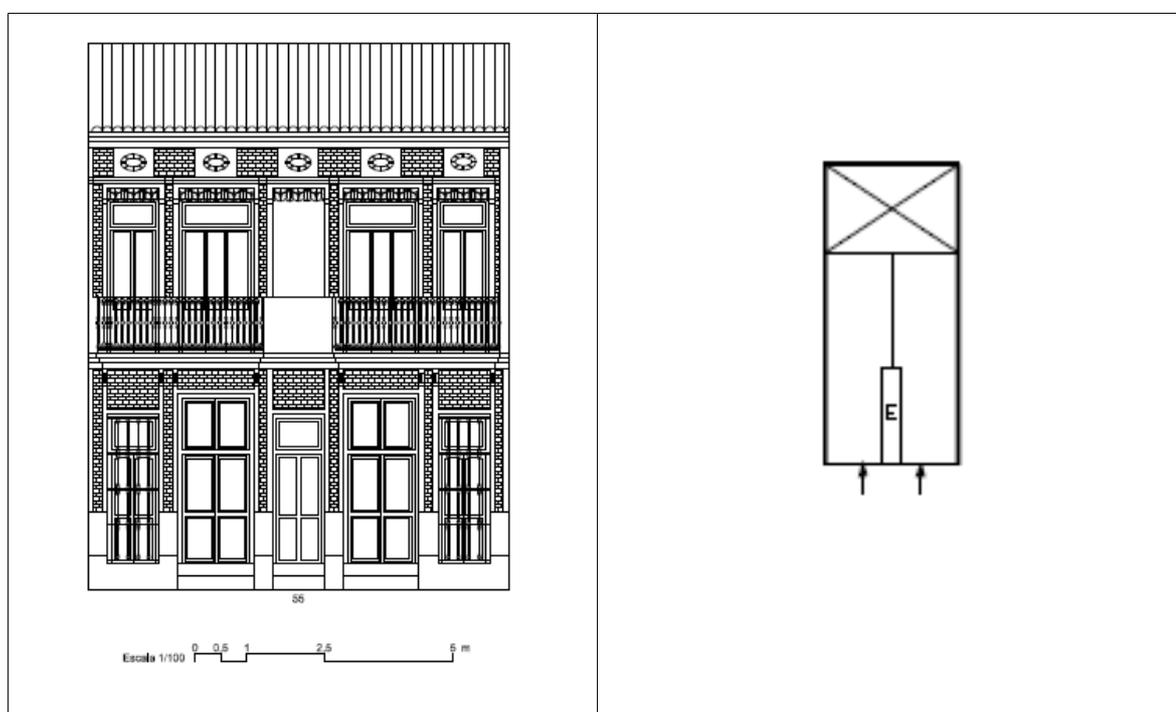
Tipo C1. Ejemplo de fachada y esquema de planta (ficha 332-17)
